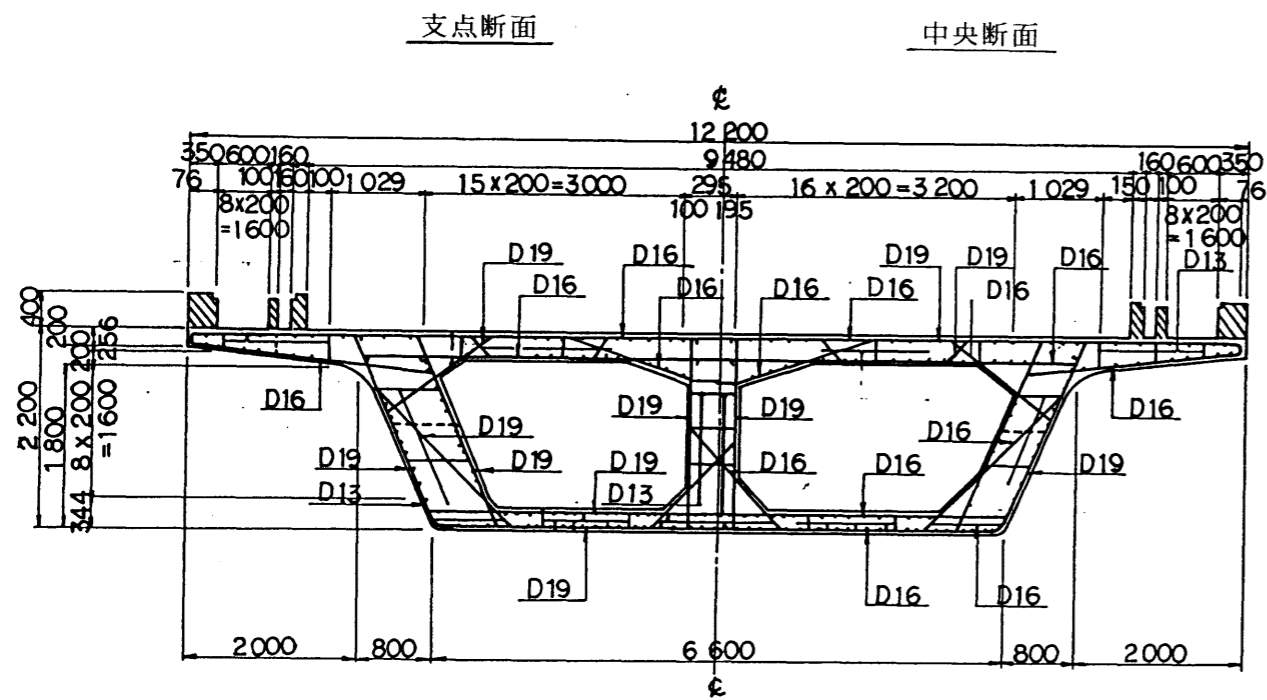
東北新幹線RC箱桁標準断面鉄筋配置図
